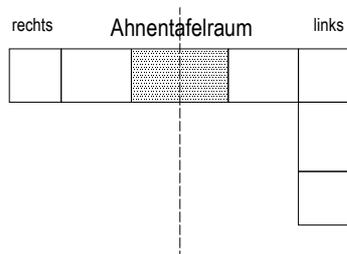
Grundriss-Schema des L-förmigen Wohnhofs
